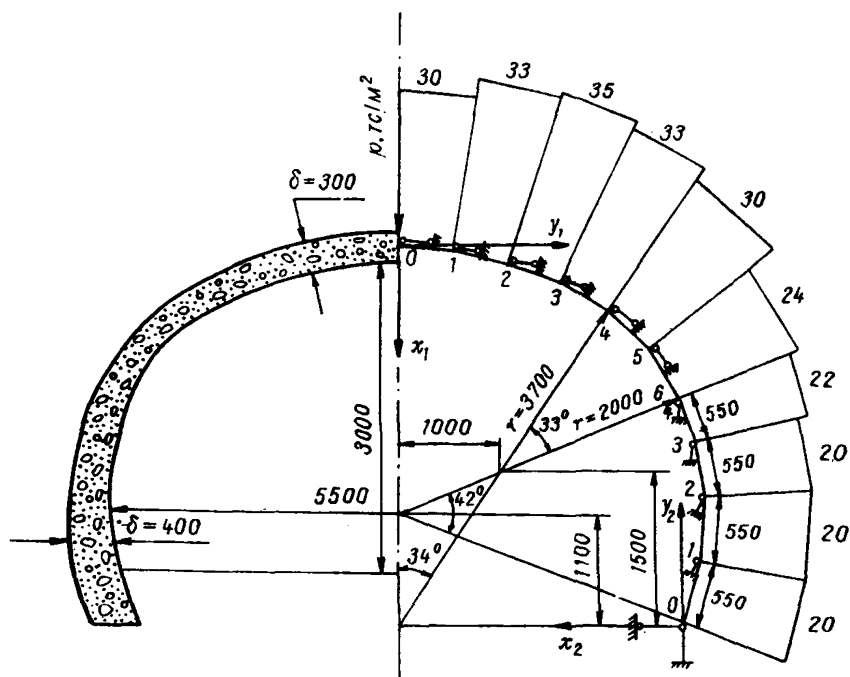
Очертание и расчетная схема сводчатой бетонной крепи
